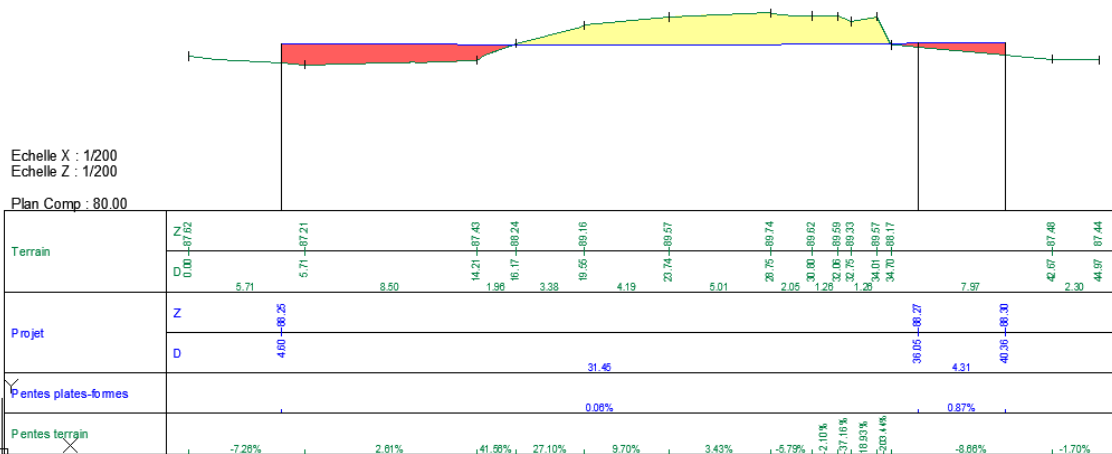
Profil en travers de l'aléa inondation 50 cm sur la station d'épuration actuelle (hors ouvrages béton hors sol)
